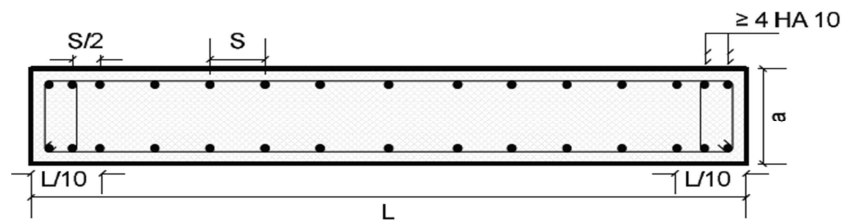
Disposition des armatures verticales dans les voiles
